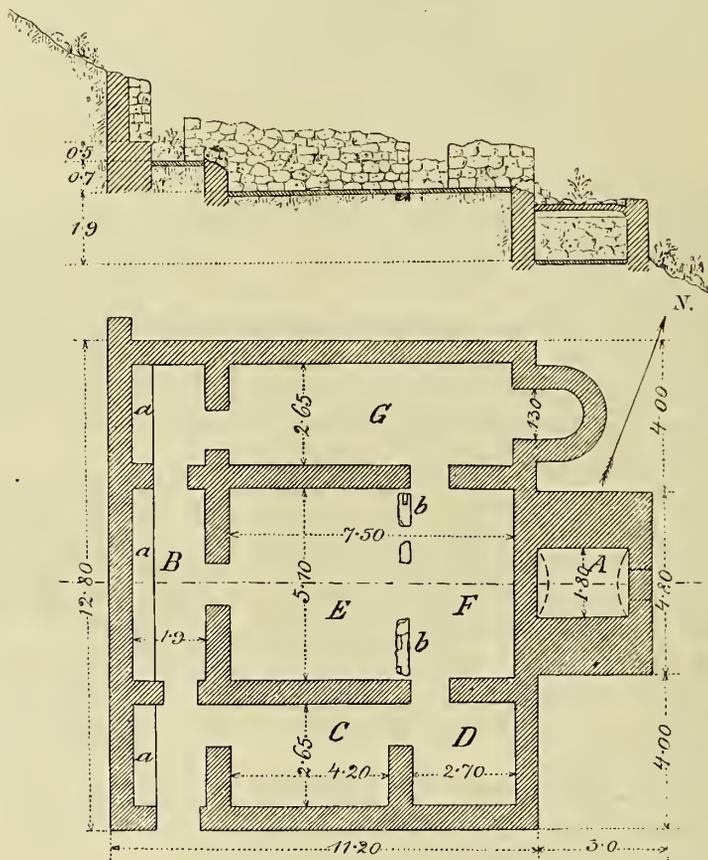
Durchschnitt und Grundriss der Kirchenruine von Dabravina.
